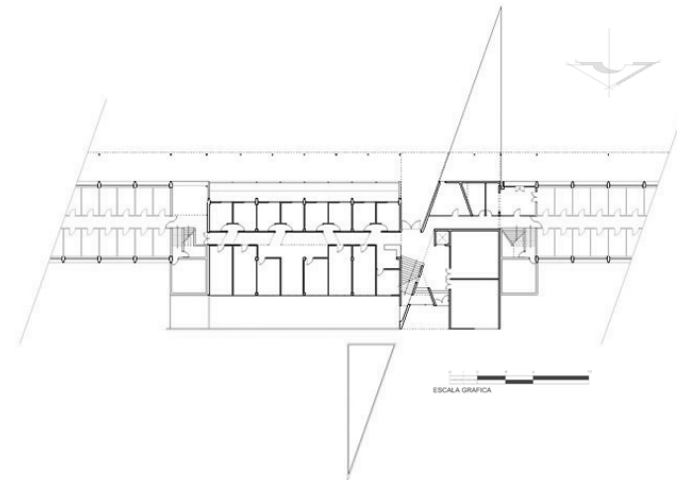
Planta baja Facultad de Matemáticas de Santiago.
